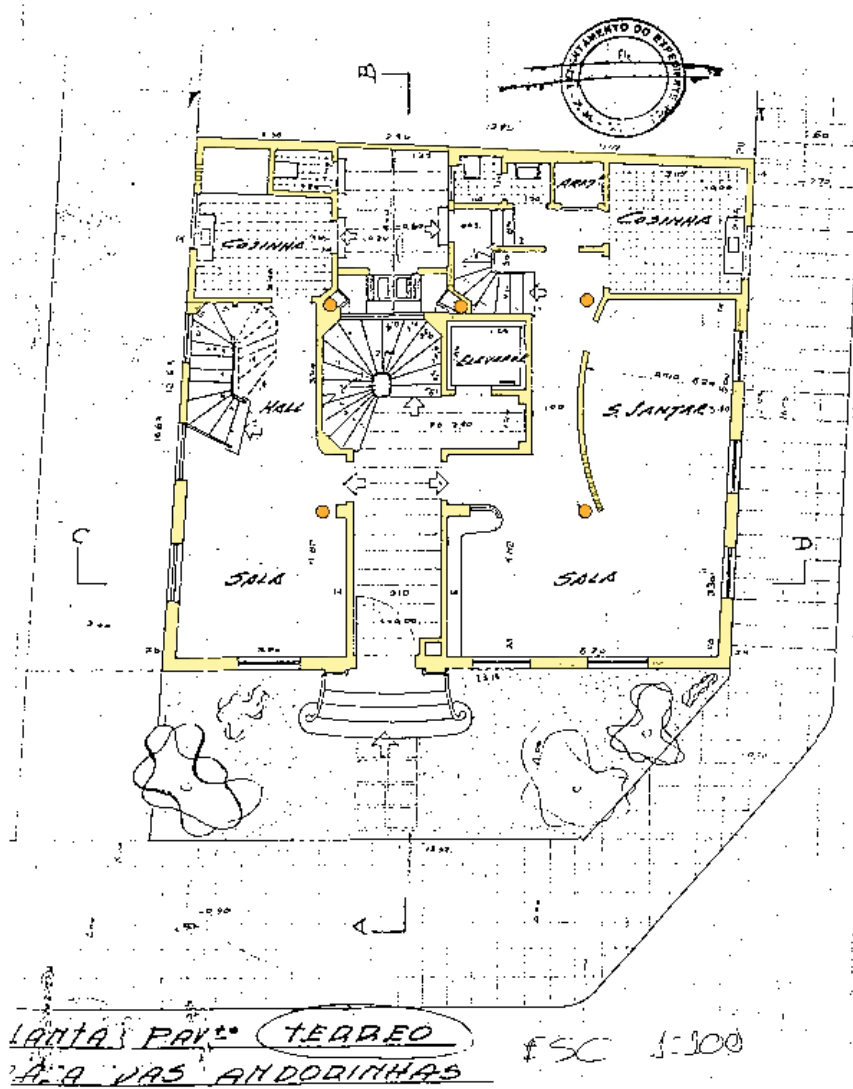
Planta do pavimento térreo do Edifício Andorinhas – 1953.
